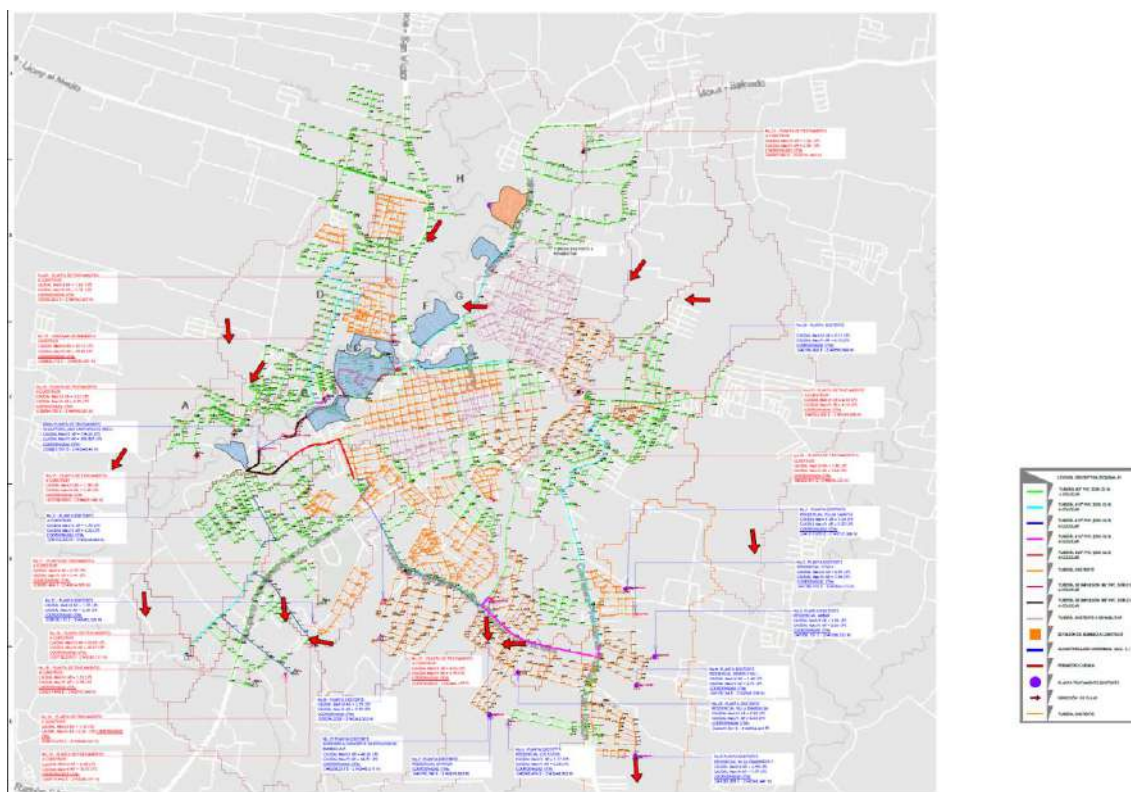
Plano de conjunto del alcantarillado sanitario de Moca
